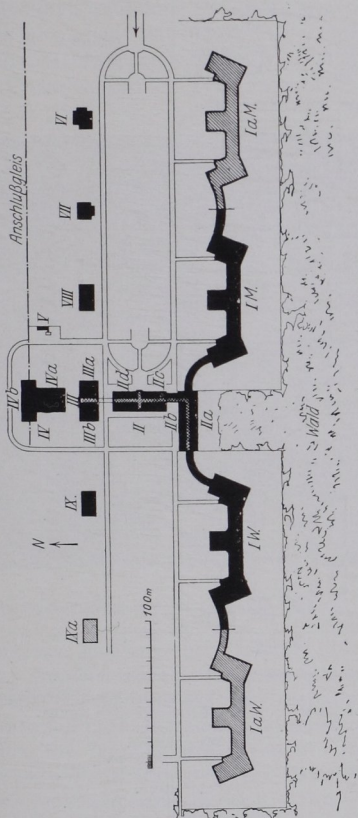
Lageplan eines Tuberkulosekrankenhauses für 400 bzw. 800 Betten.
